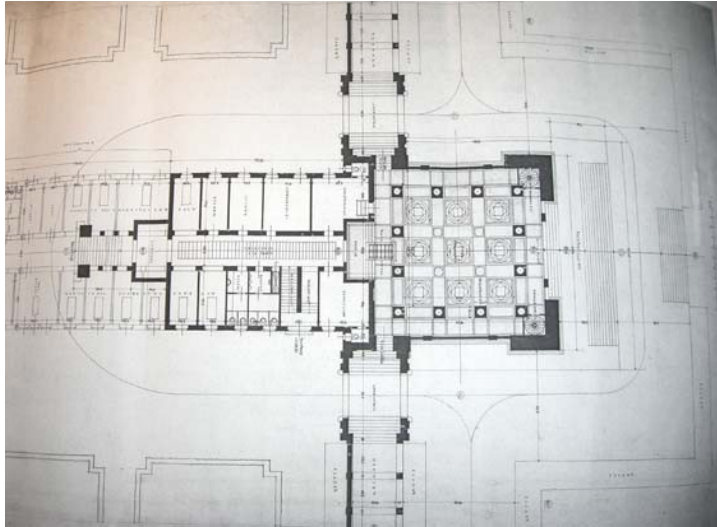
„Confessio“ Grundriss Erdgeschoß
